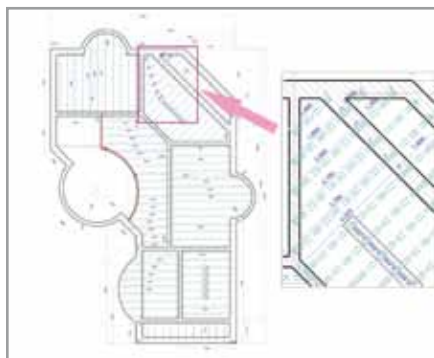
Перекрытие МАРКО-СТАНДАРТ с криволинейным контуром и его монтажная схема
